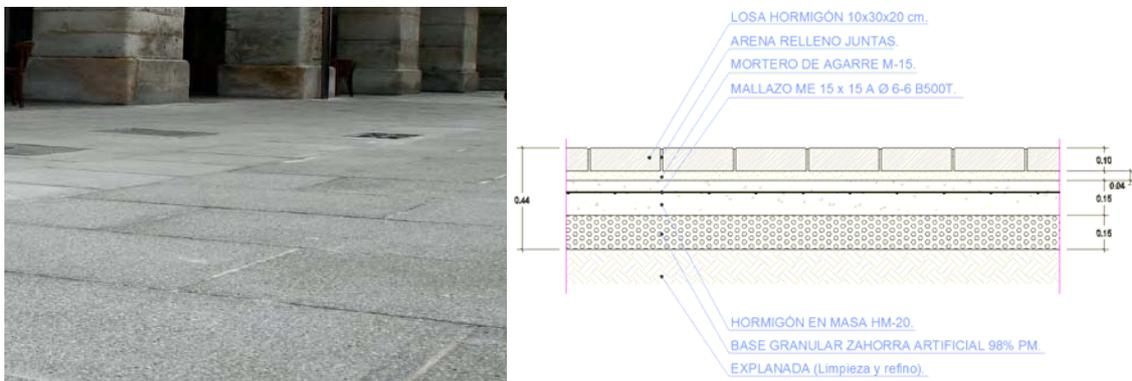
Losa descontaminante de hormigón prevista en las zonas de parada de la actuación.
